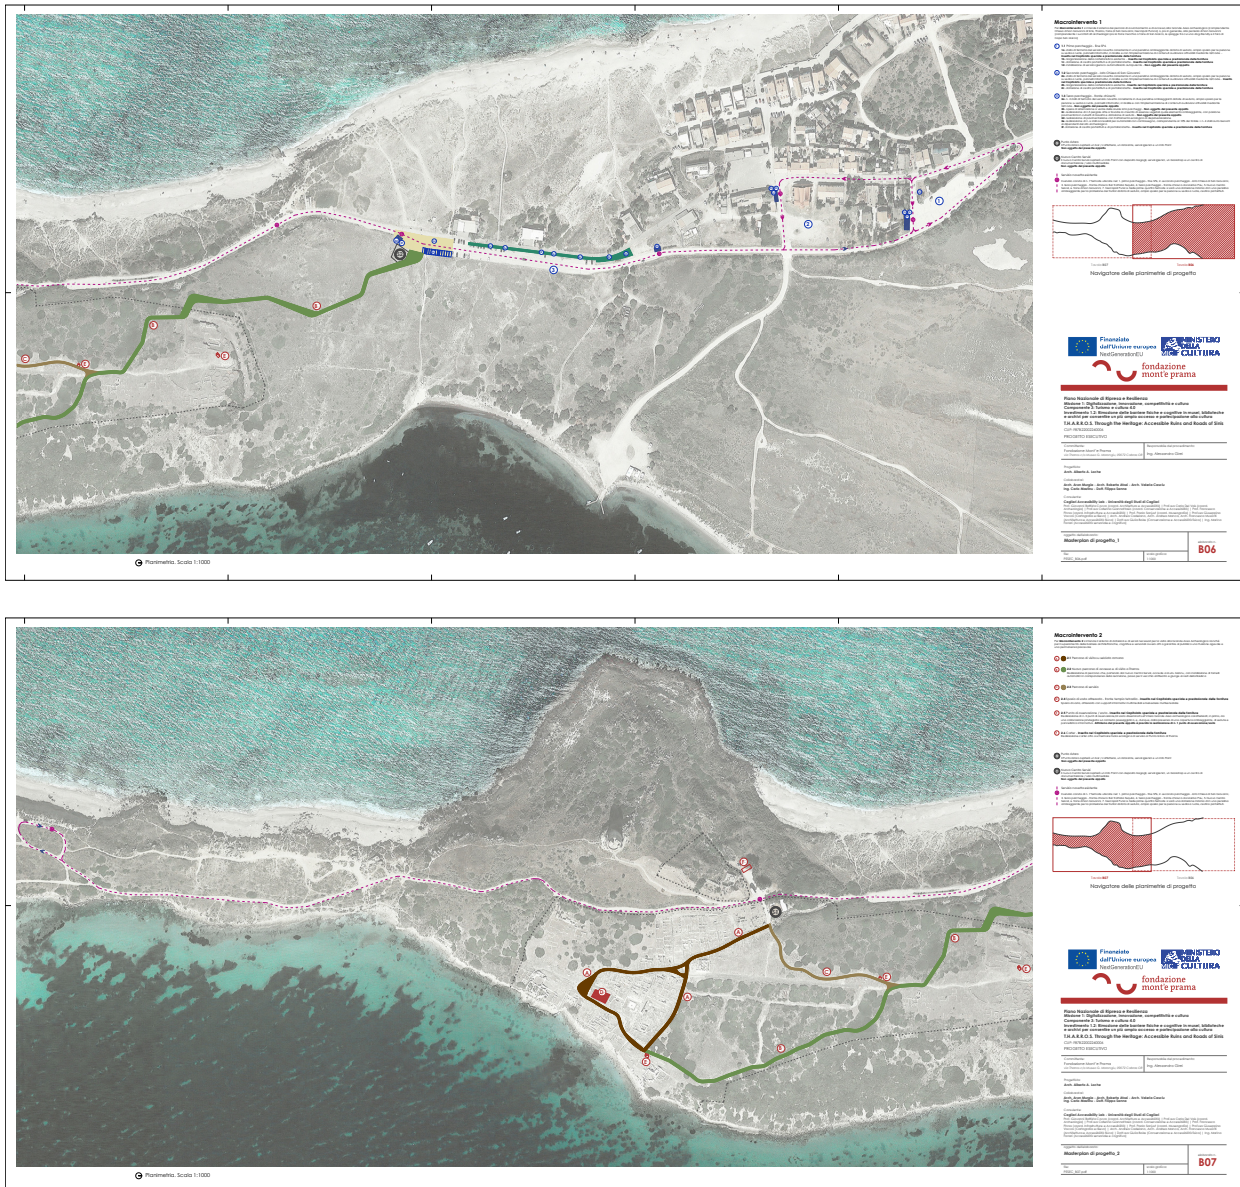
Masterplan di progetto su ortofoto (Tav. PESEC\_B06 – B07)
